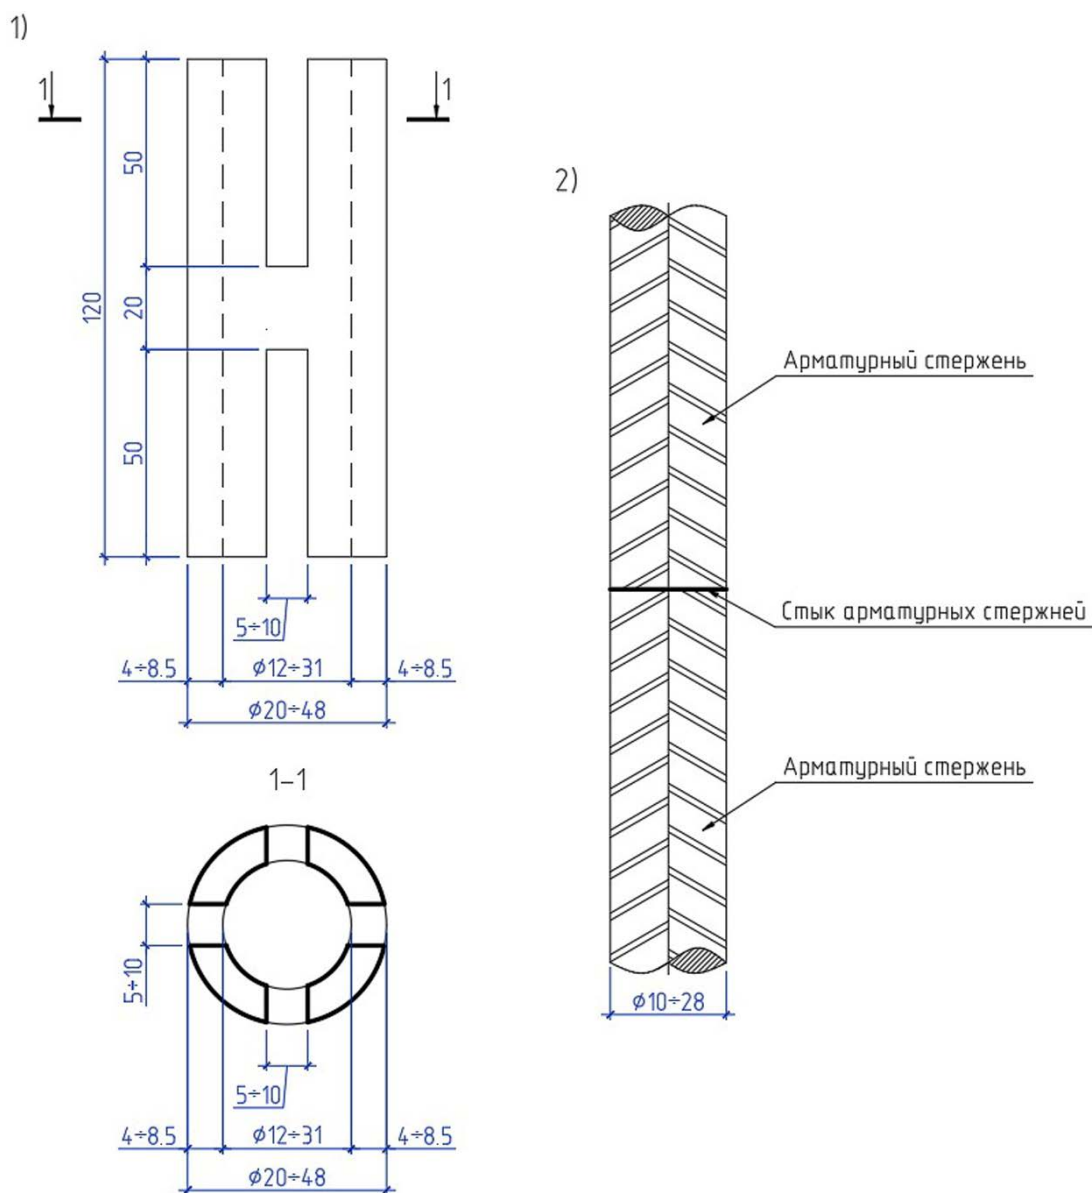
Элементы сварного соединения арматурных стержней с помощью металлической муфты-втулки с прорезями для сварки: 1 – металлическая муфта-втулка (примерная длина – 120 мм; наружный диаметр – 20–48 мм; внутренний диаметр – 12–31 мм; толщина стенки – 4–8,5 мм) с прорезями (ширина прорезей – 5–10 мм; примерная длина прорезей – 50 мм); 2 – арматурные стержни (номинальный диаметр – 10–28 мм)
